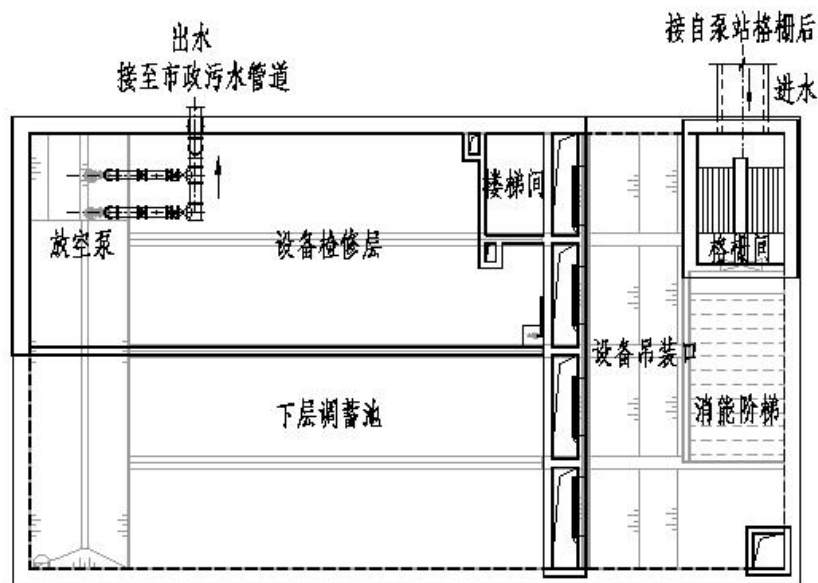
全地下式钢筋混凝土调蓄池平面示意图
